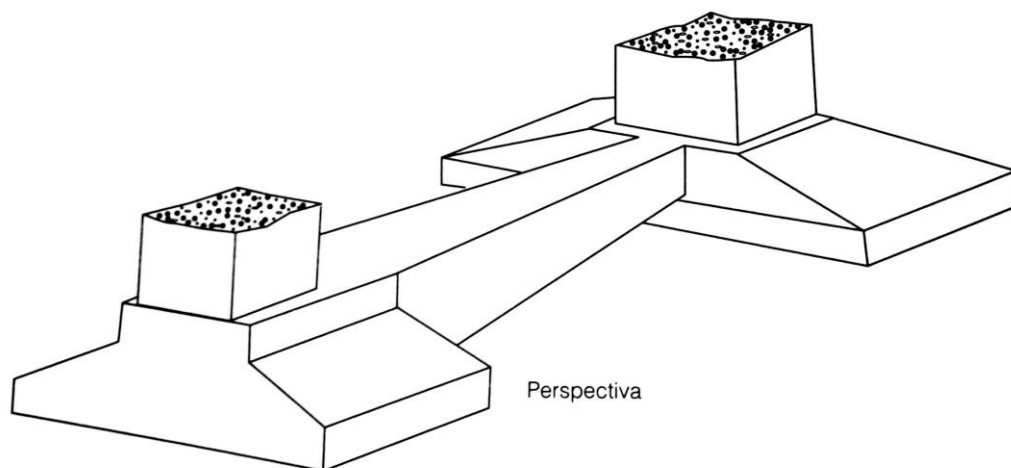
Desenho esquemático de uma viga de equilíbrio - Perspectiva
